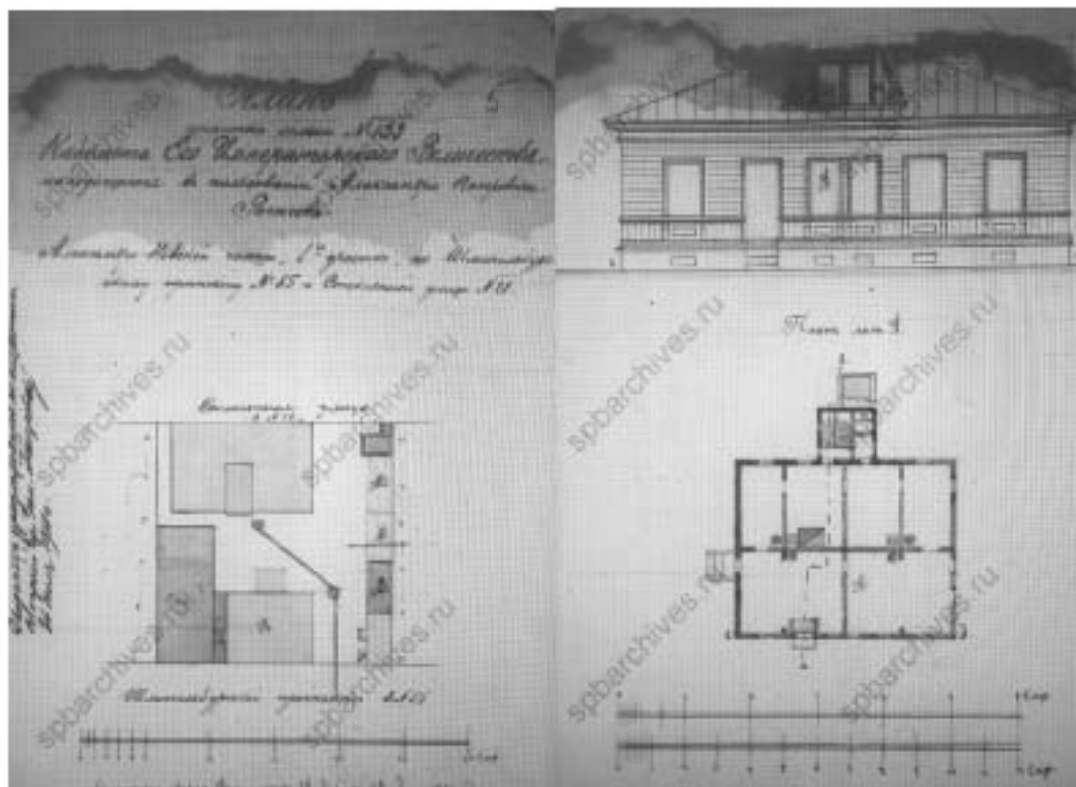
План участка, фасад здания по адресу Стеклянная ул., 28/Шлиссельбургский пр.,55
